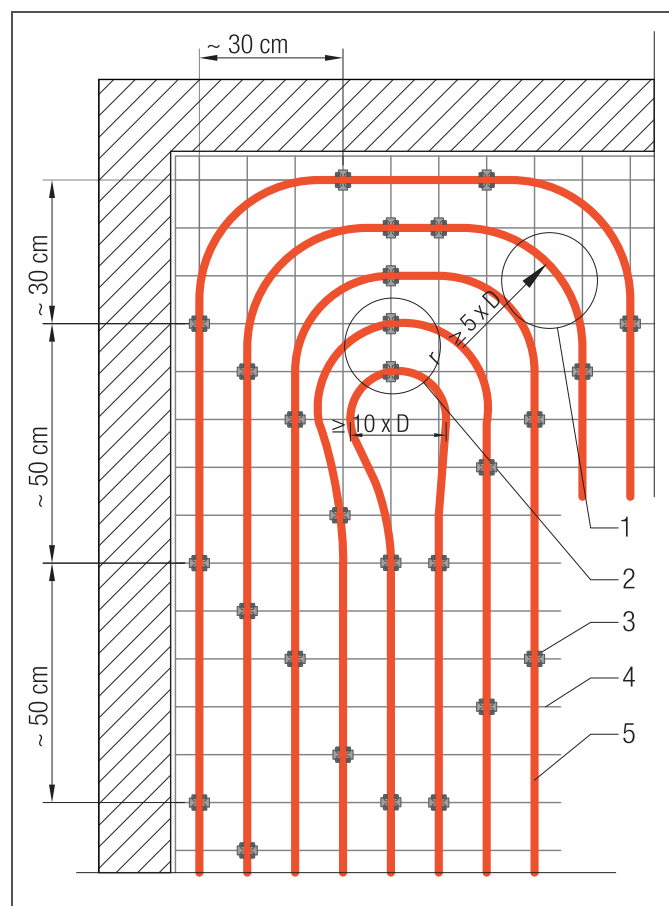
Формирование разворотной петли в регистре отопительных труб. Пример укладки трубы RAUTHERM S 17 x 2,0 с шагом 100 мм на RTM 100
